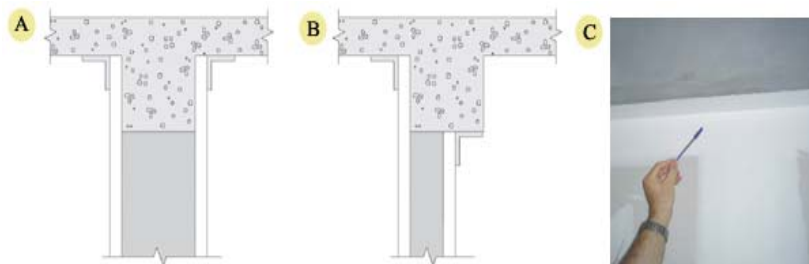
Encontro entre parede *dry-wall* e viga (ou pilar)
